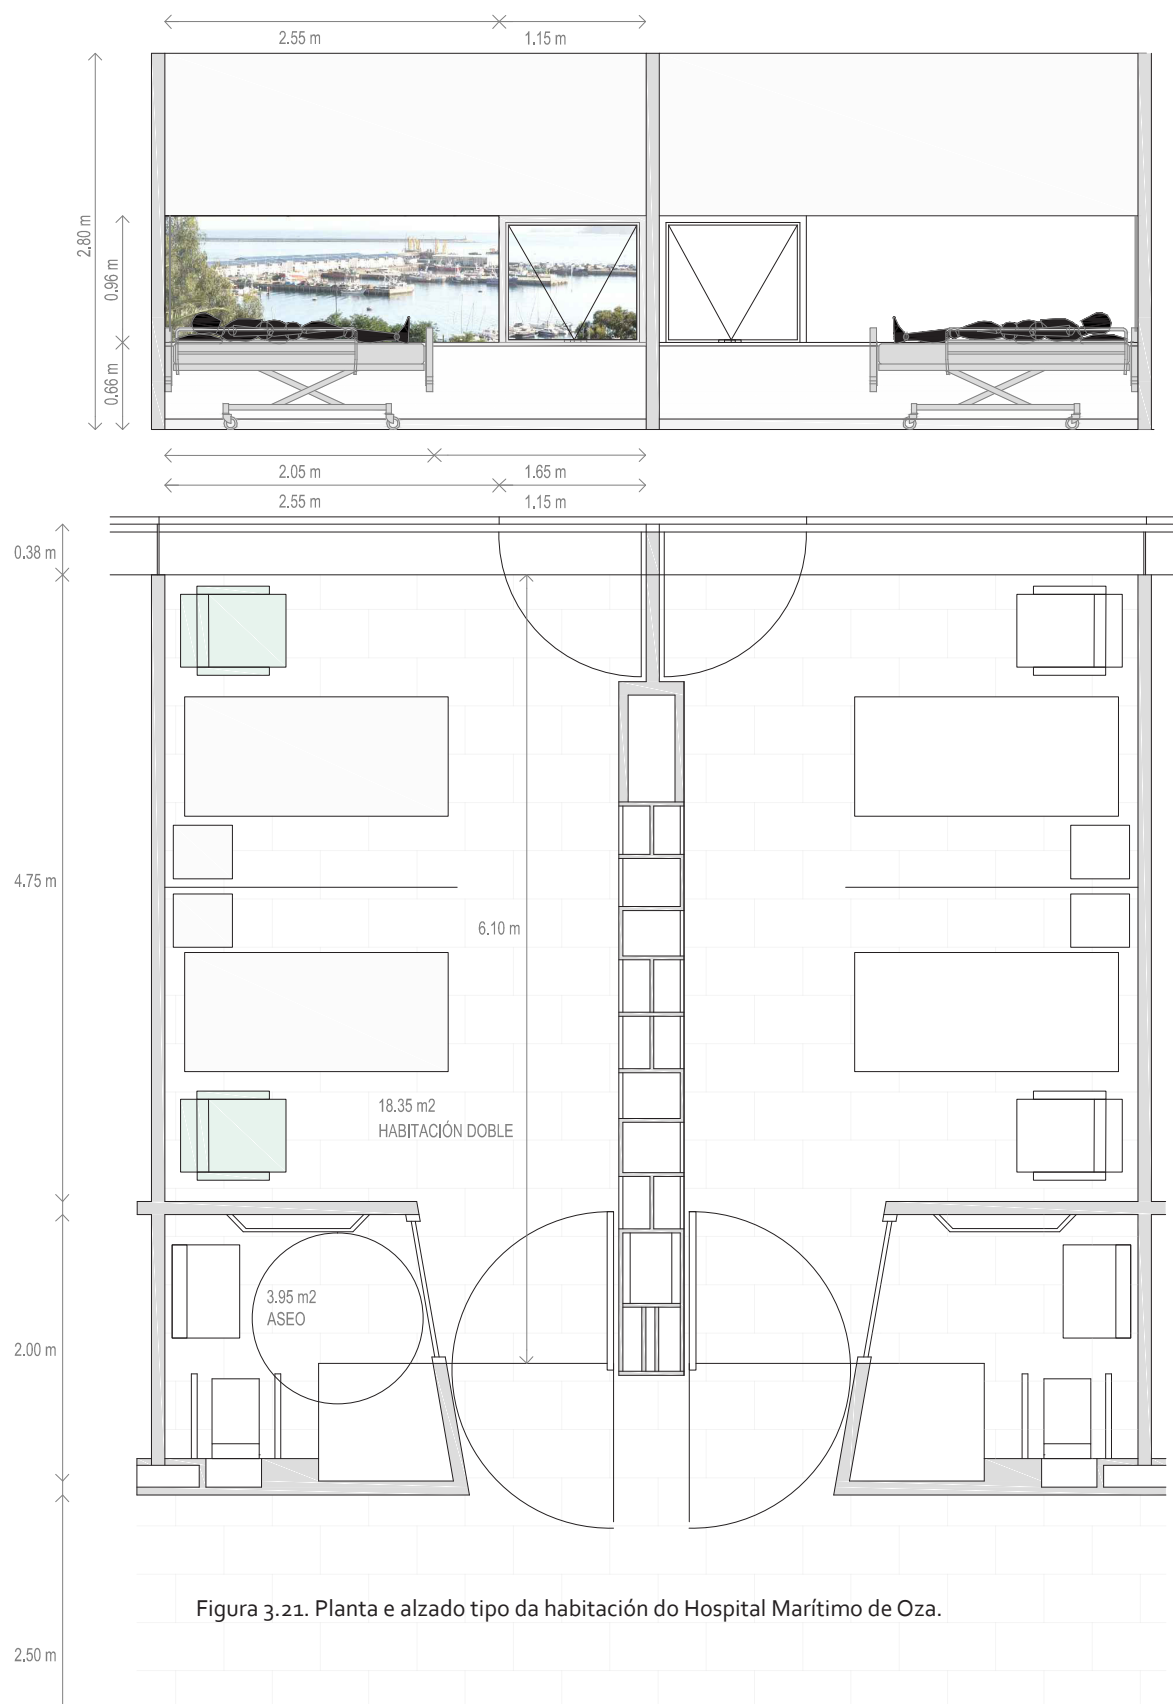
Planta e alzado tipo da habitación do Hospital Marítimo de Oza.
